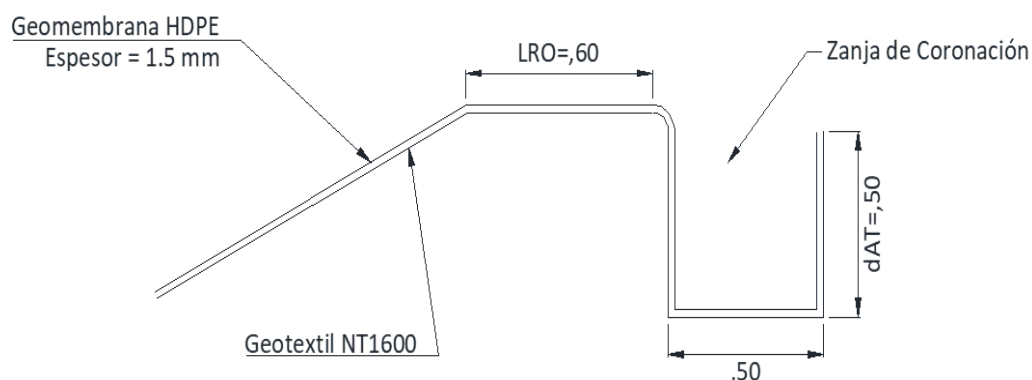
Dimensionamiento Longitud desarrollo y Zanja de anclaje.
